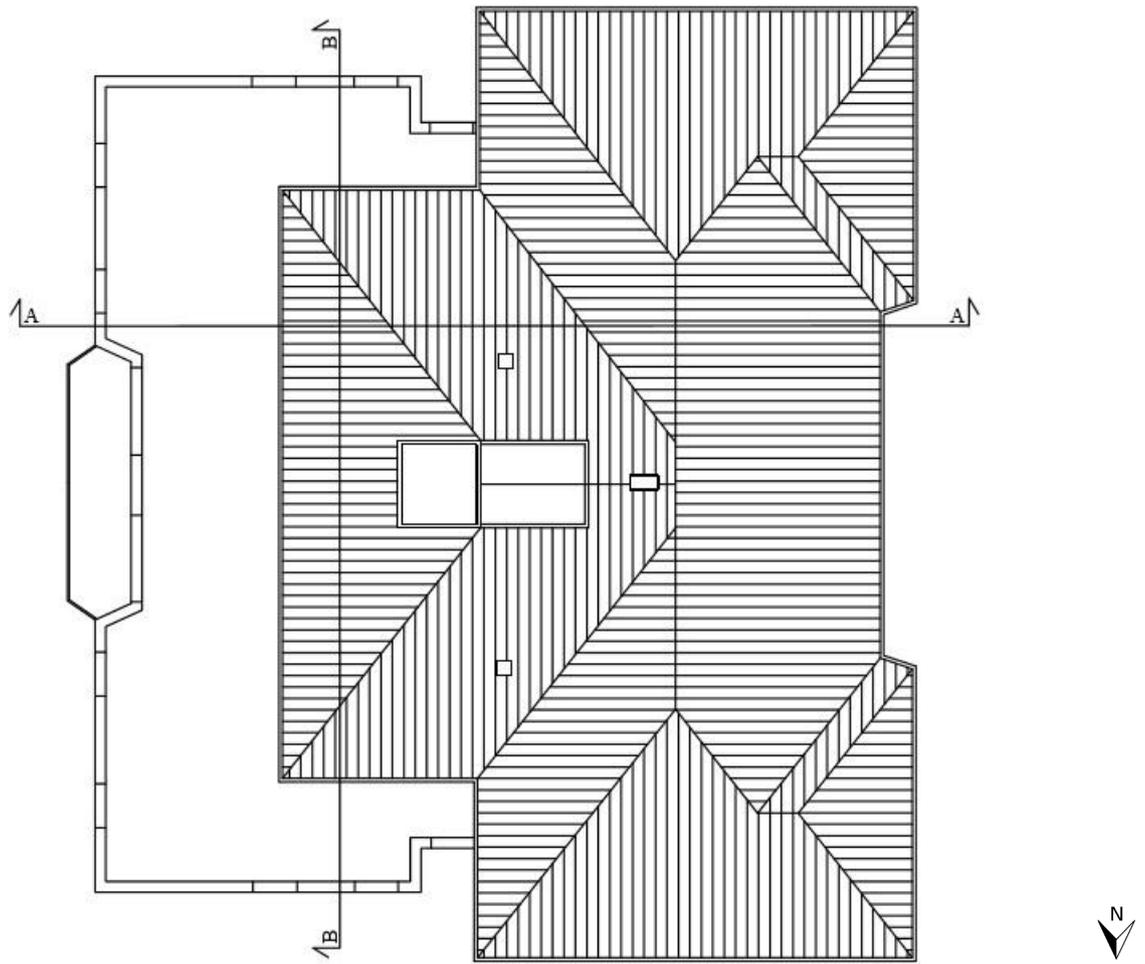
Pianta copertura, via Brofferio 1. Scala 1:200. Fonte: Ater Padova.
